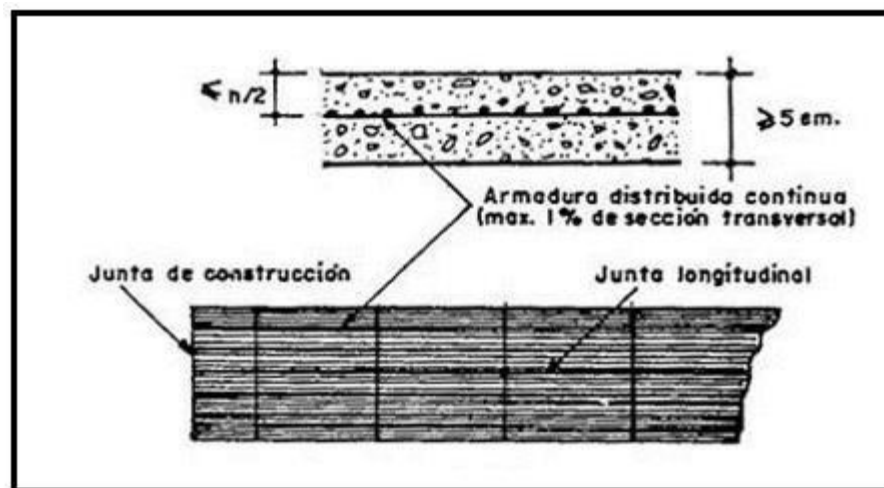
Pavimentos de concreto con refuerzo de Acero Continuo
